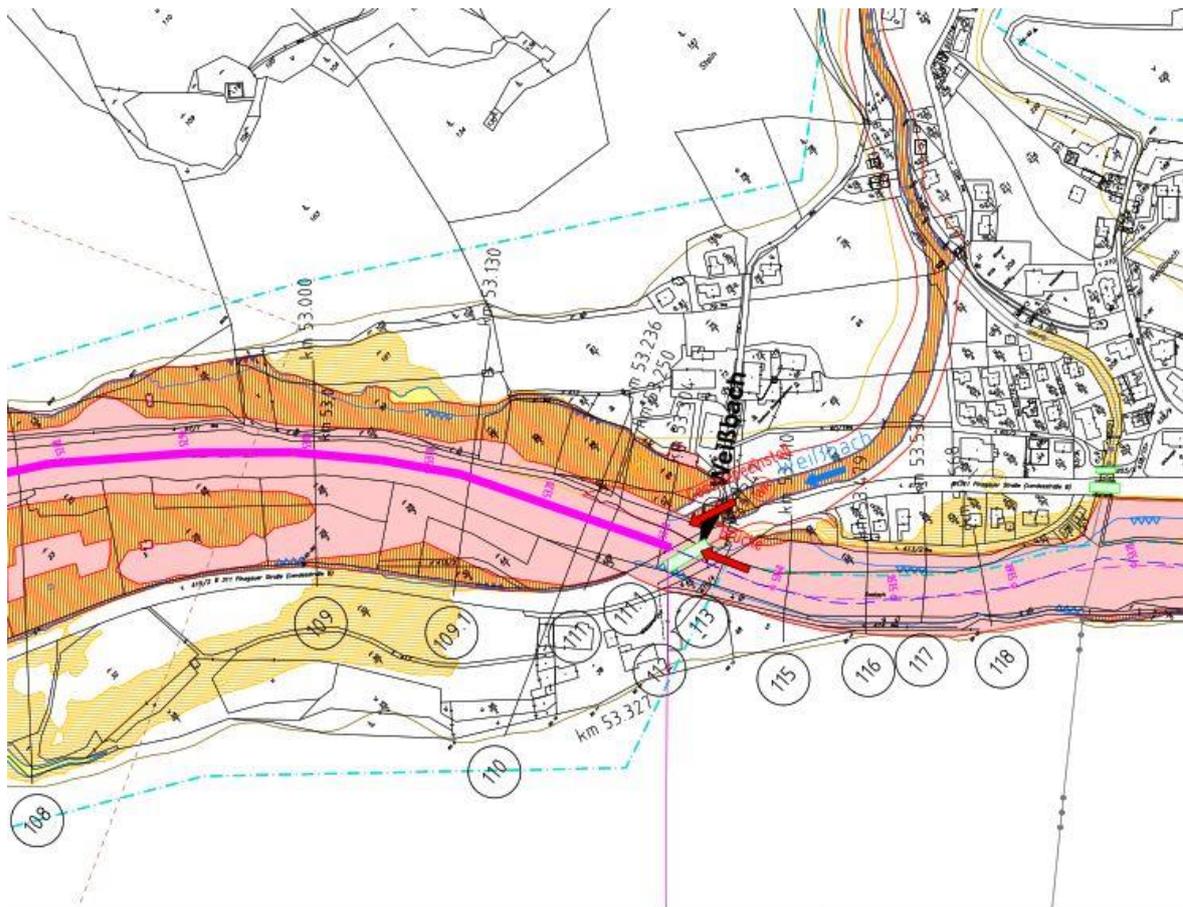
Lageplanausschnitt Gemeinde Weißbach; Darstellung der Gefahrenzonen
